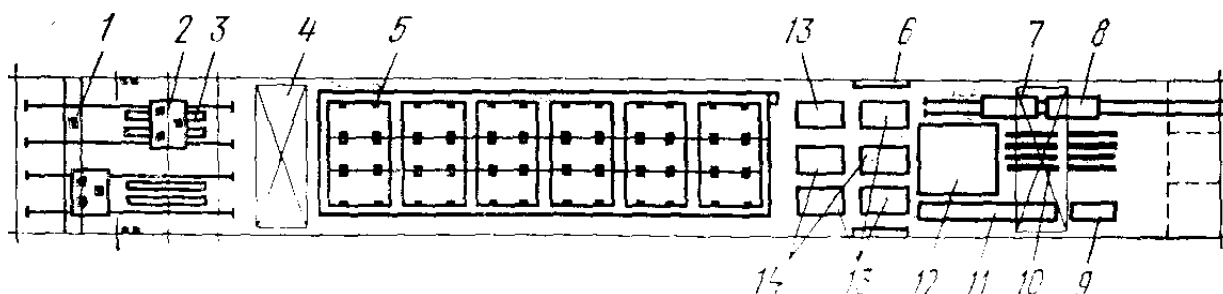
Схема агрегатно-поточной линии для изготовления железобетонных изделий размером 3X6 м: 1—раздаточный бункер; 2 — бетоноукладчик; 3—виброплощадка; 4 — мостовой кран; 5—пакетирующий форм; 6 — установка для электронагрева арматурных стержней; 7 — самоходная тележка; 8 — тележка-прицеп; 9—стенд для контроля и ремонта изделий; 10 — стойки для ремонта изделий; 11—склад арматурных стержней; 12 — площадка для выдержки изделий; 13 — пост для распалубки и сборки форм; 14 — склад арматурных сеток
